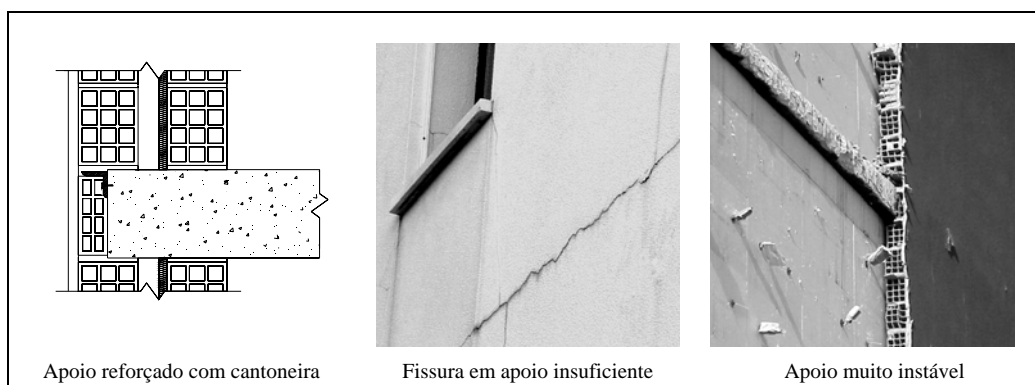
Exemplo de reforço de apoio viável e de situações de fissuração e instabilidade
